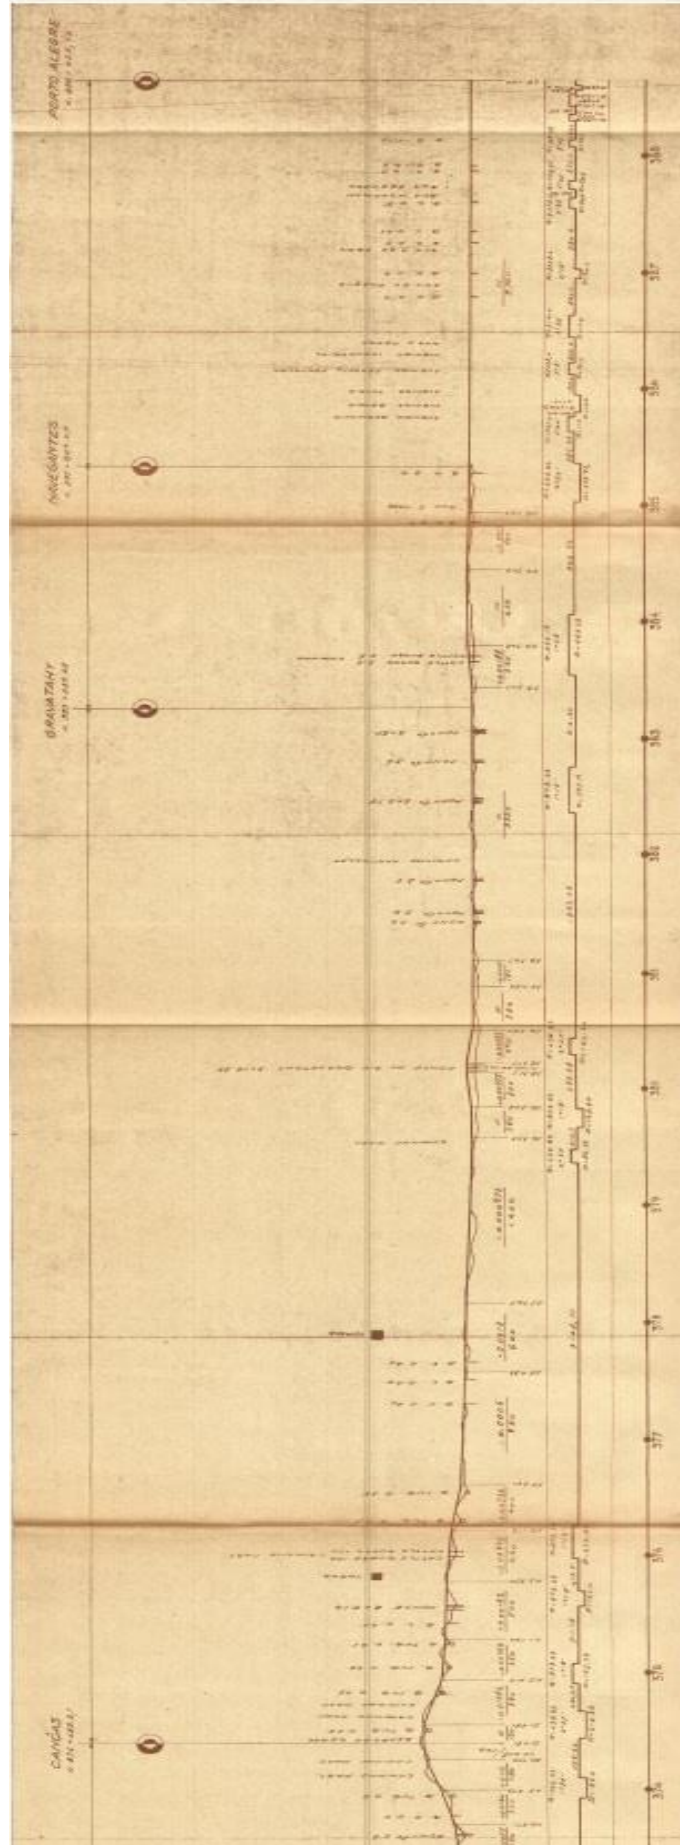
Fragmento da planta de Perfil Longitudinal do trecho Porto Alegre–São Leopoldo, RS (recorte do segmento Porto Alegre–Canoas).
